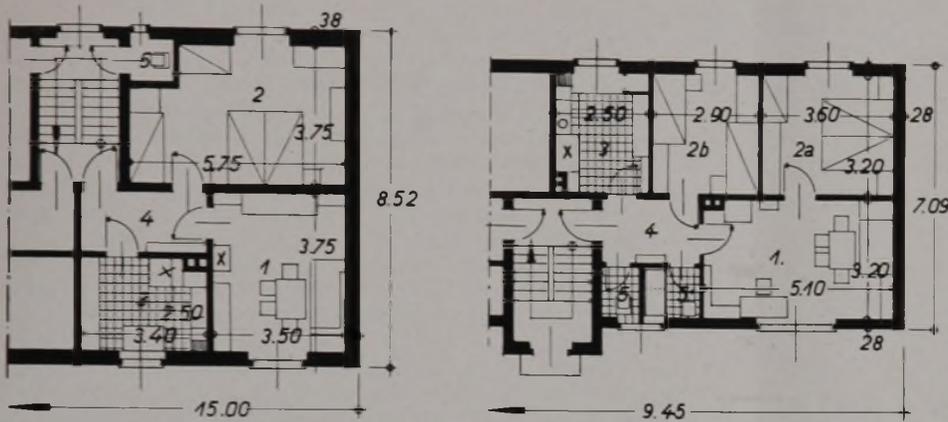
Bei gleicher Bausumme von 28 500 RM. für ein 6-Familien-Haus ergibt verbesserte Bauweise höhere Nutzfläche und bessere Grundrißblösung.
